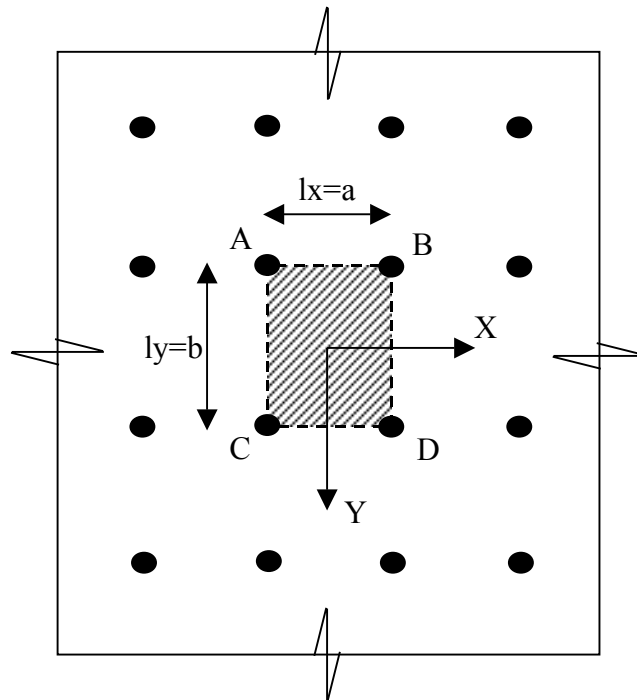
Laje plana apoiada sobre pilares (Szilard).
